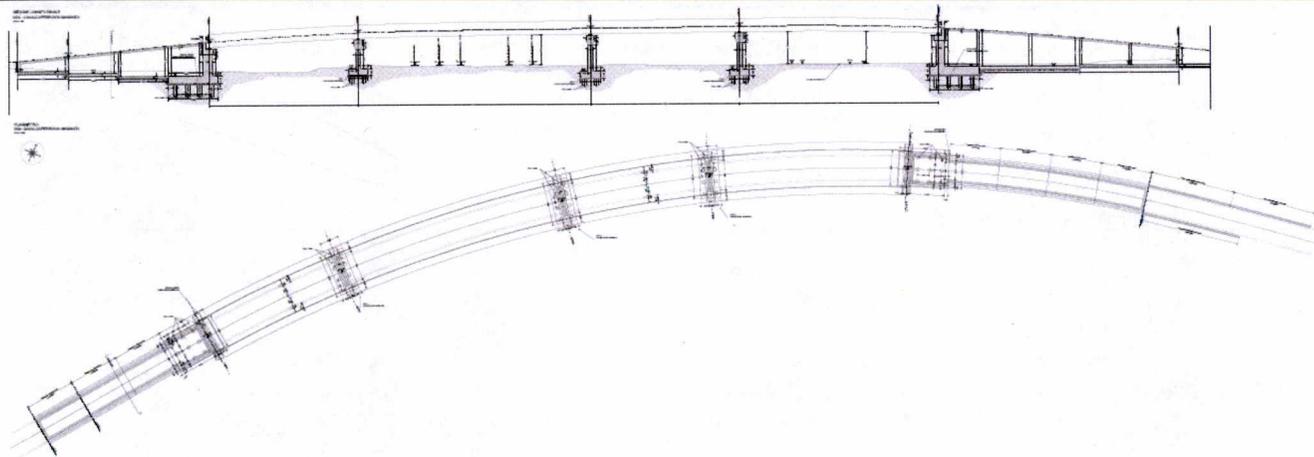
Planimetria e Profilo del Cavalcaferrovia Maganza
